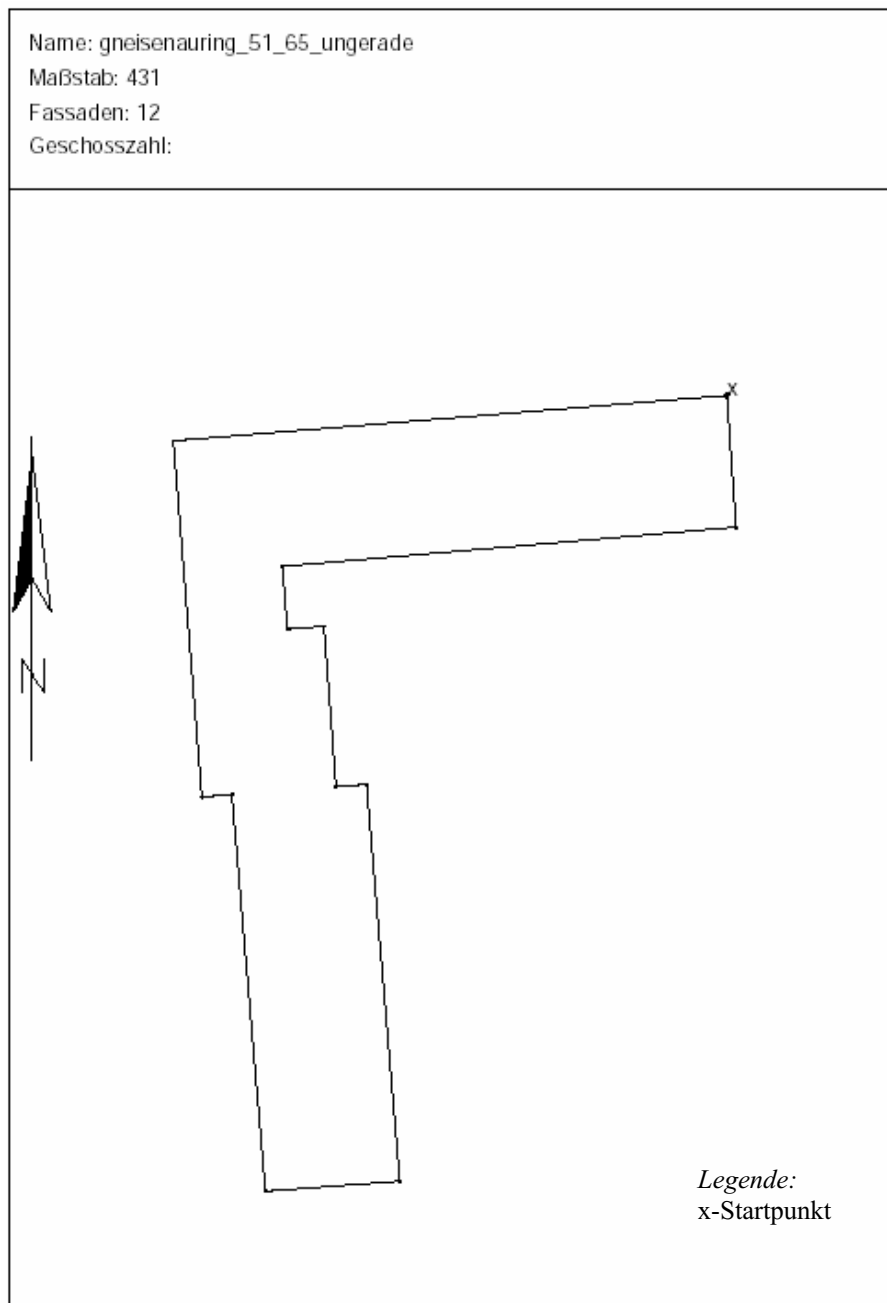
Feldbuch (Grundriss) Gneisenauring 51-65 (ungerade)
